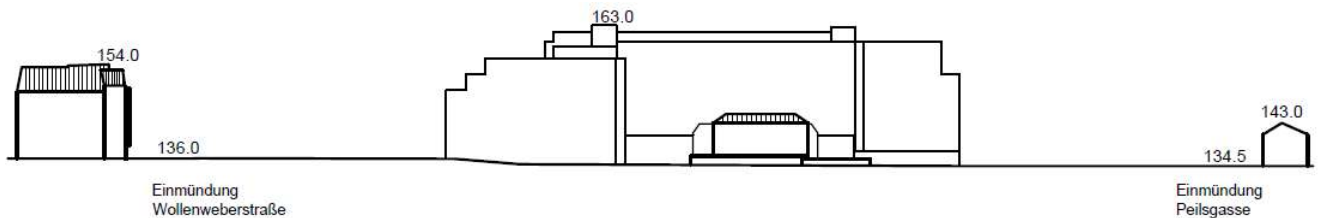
Schematische Fassadenabwicklung Indestraße, Höhenangaben näherungsweise in m ü NNH [Quelle: Stadt Eschweiler]
